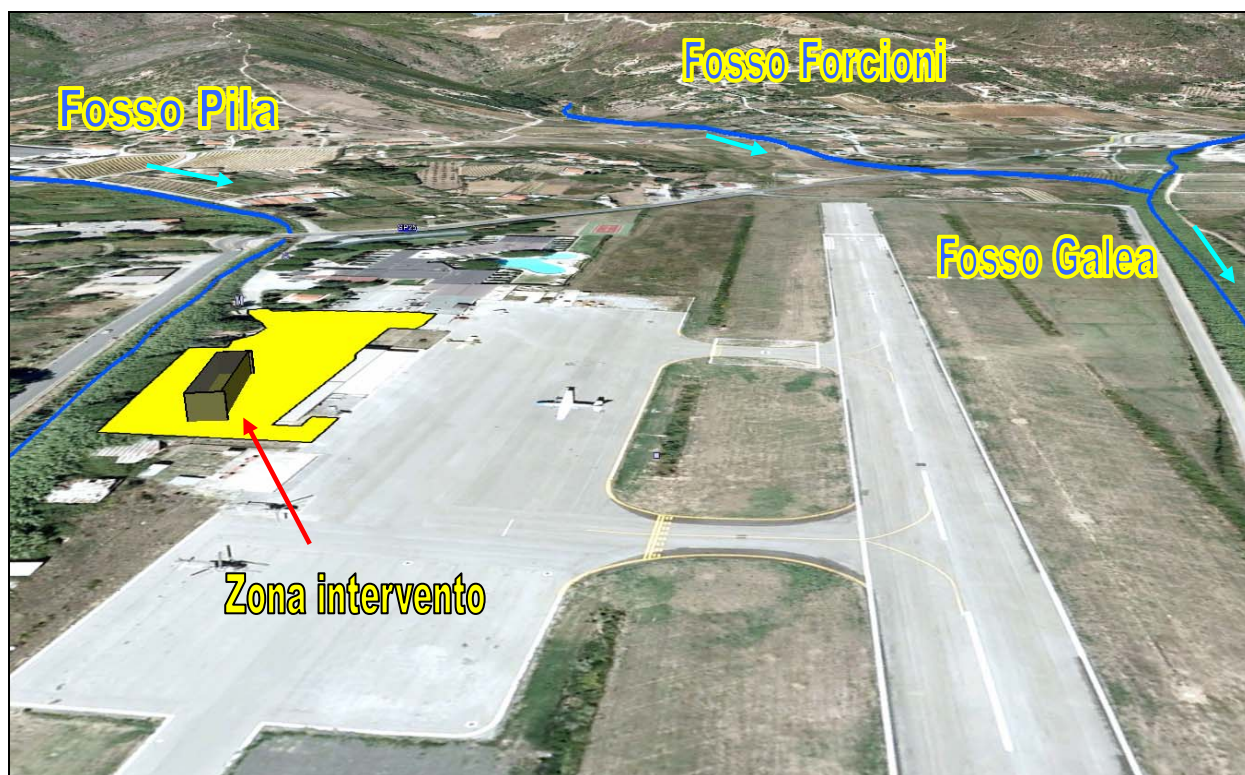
Vista prospettica della zona dell'intervento, con visione del reticolo idraulico a monte di esso. In giallo l'area globale dell'intervento, in grigio la sagoma dei fabbricati
